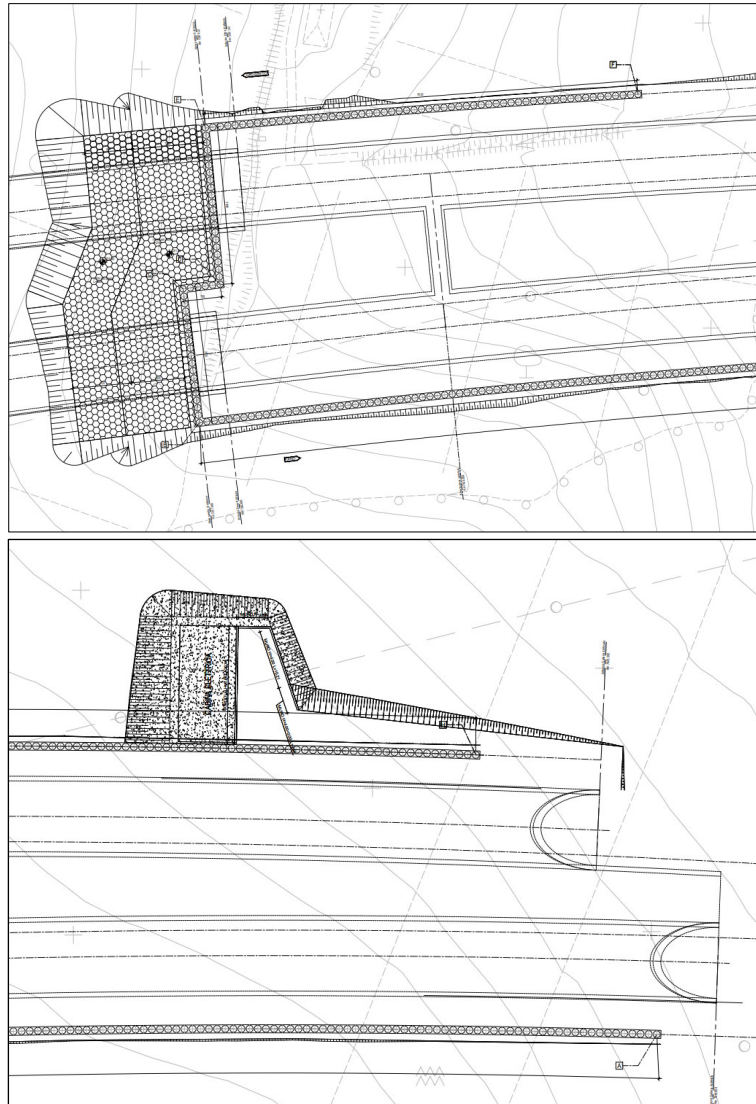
Planimetria delle gallerie artificiali di imbocco GA07 e GA08
